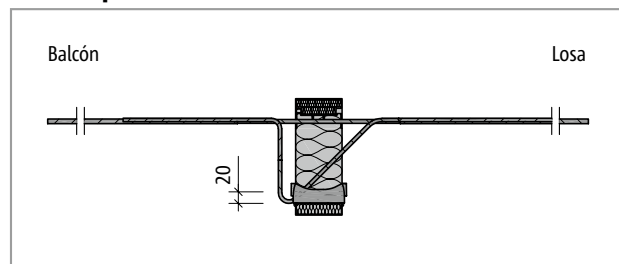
Schöck Isokorb® T tipo K-M1 hasta M4: Sección del producto
